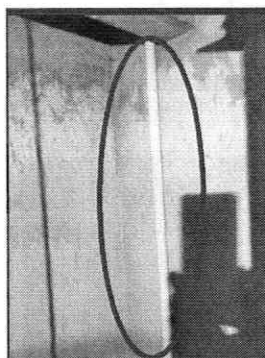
Instalaciones ajenas (Tuberías en el foso).
